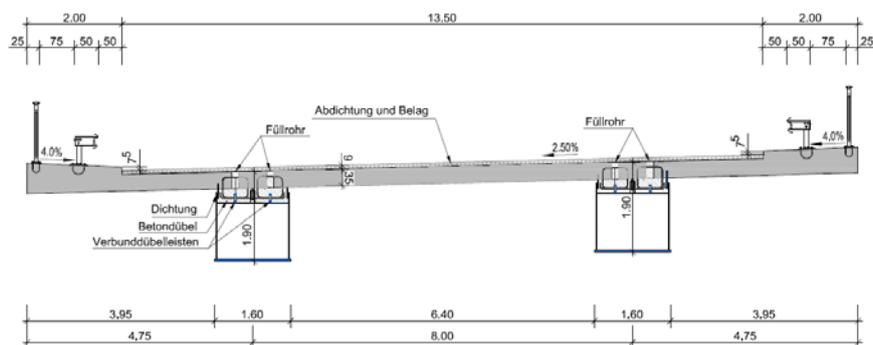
Querschnitt einer Brücke in modularer Bauweise
